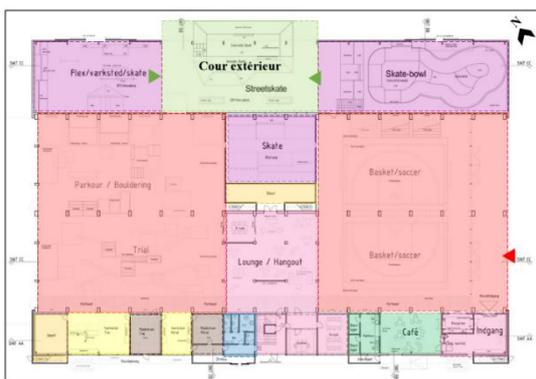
Plan de RDC (Source: Archidaily.com (traité par l'auteur))
